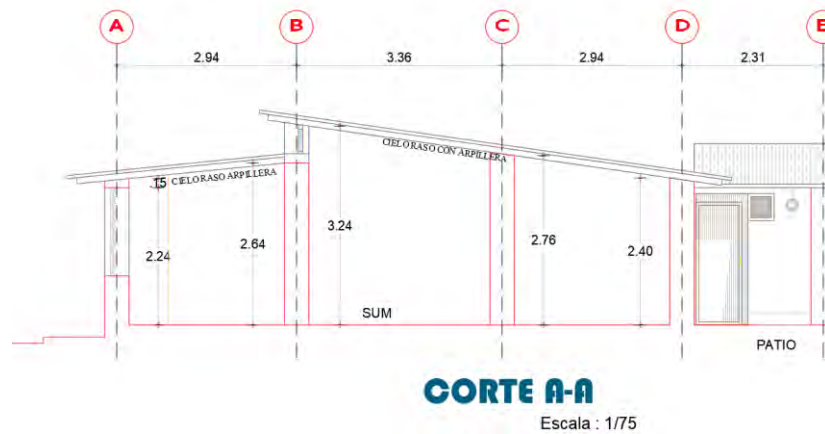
Elevación de la edificación - corte A-A - Orcopampa
